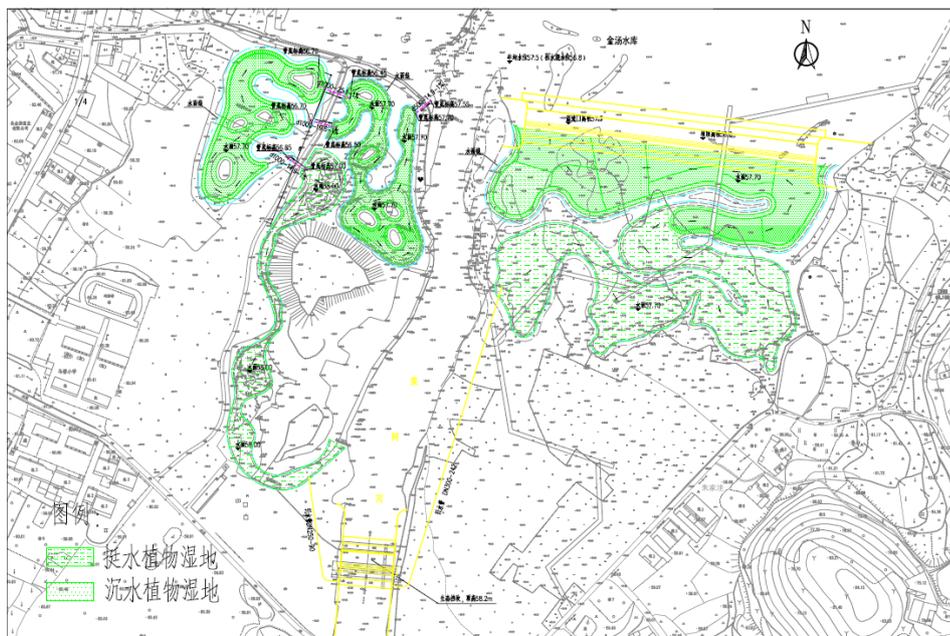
果树河湿地处理系统总平面布置
